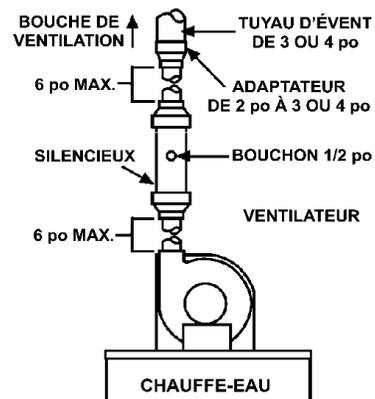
Installation verticale type dans un système constitué d'un tuyau de 3 ou 4 po
